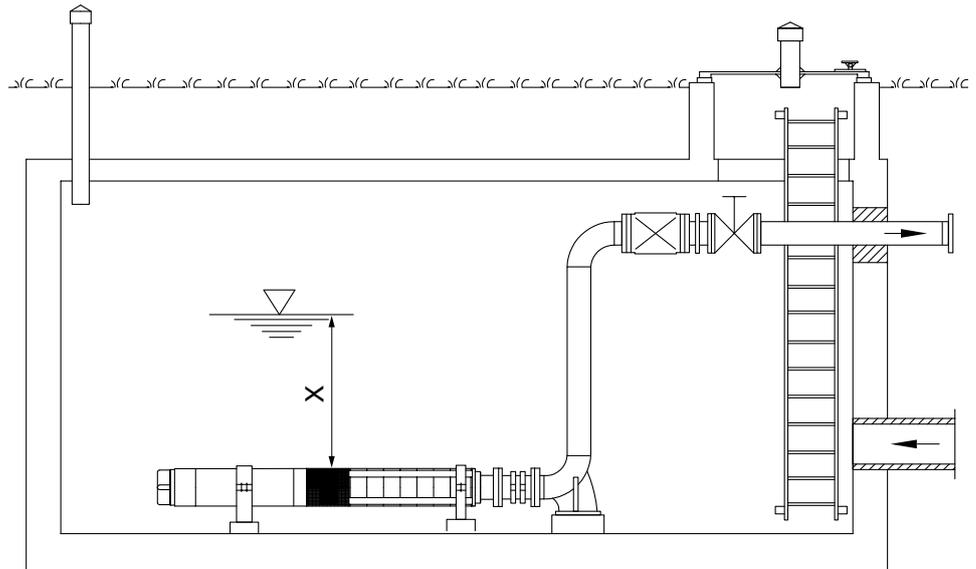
Mindestüberdeckung bei horizontalem Einbau
